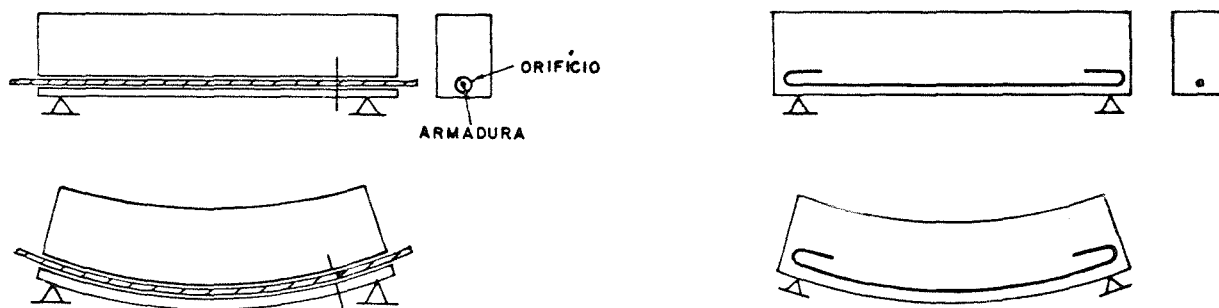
Viga com armadura sem aderência Figura 1.2—Viga com armadura aderente
